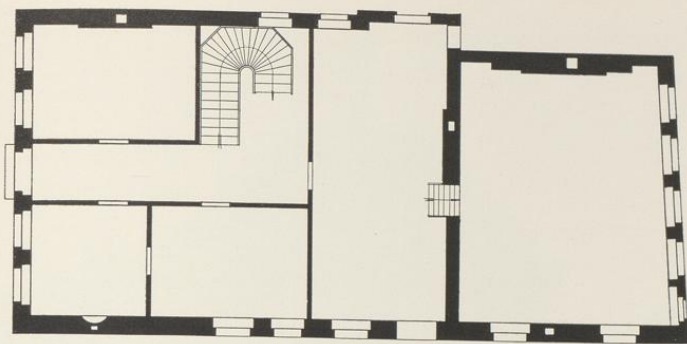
Grundriß des Hauses Agidiistraße 8
